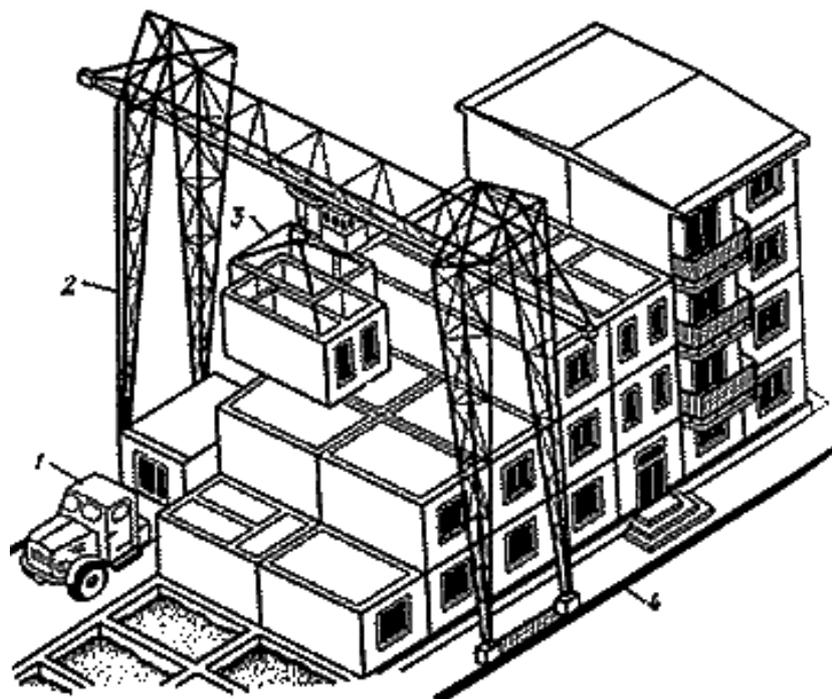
Схема монтажа зданий из блок-комнат: 1 – блок-воз; 2 – козловой кран; 3 – траверса; 4 – подкрановый путь
